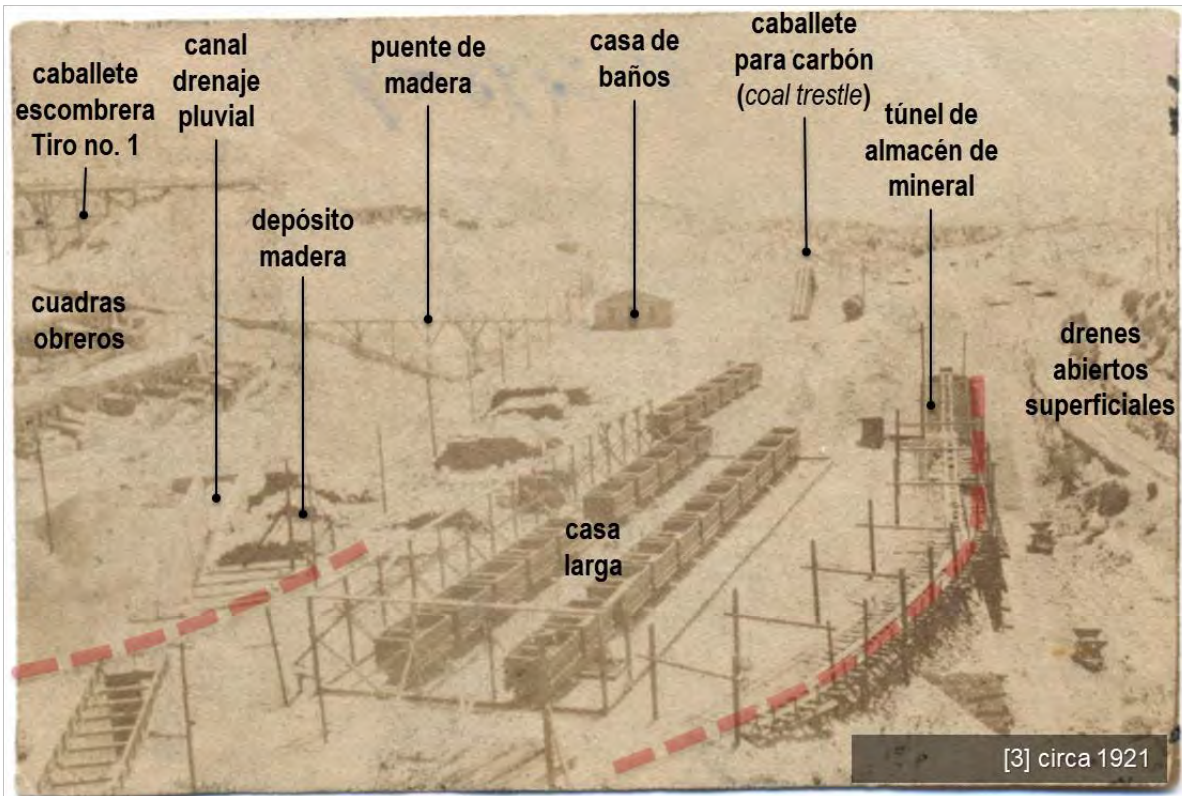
Instalaciones de El Potosi Mining Company en Santo Domingo circa 1921. [3] Vista de la sección Suroeste del conjunto, al centro aparece la primera casa de baños, construida de muros de ladrillo, este edificio se transformó en 1935 en sanitarios de la Escuela Oficial No.367, la línea roja discontinua marca la vía angosta de 30" del ferrocarril; [1] Detalle de canal de drenaje pluvial abierto, construido de muros de concreto, y solución para el cruce del ferrocarril de vía angosta; [2] ubicación de la primera casa de baños. Fuente: [1] Detalle de canal de drenaje pluvial, 1921. AHEP, SA, caja 74 expediente 6. [2] Elaboración propia con base en plano del 11 de abril de 1921 y su relación de edificios. AHEP, SSH, caja 7 expediente 8. [3] Fototeca Centro INAH Chihuahua, sin no. de inventario.
